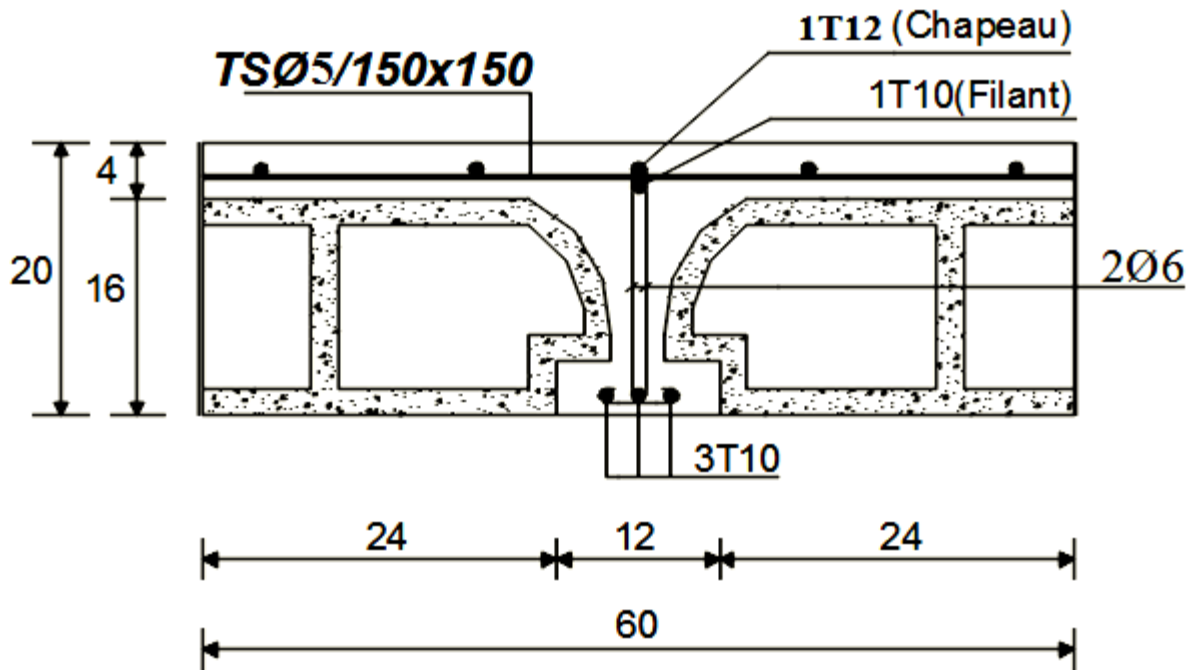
Coupe transversale d'un plancher à corps creux.
